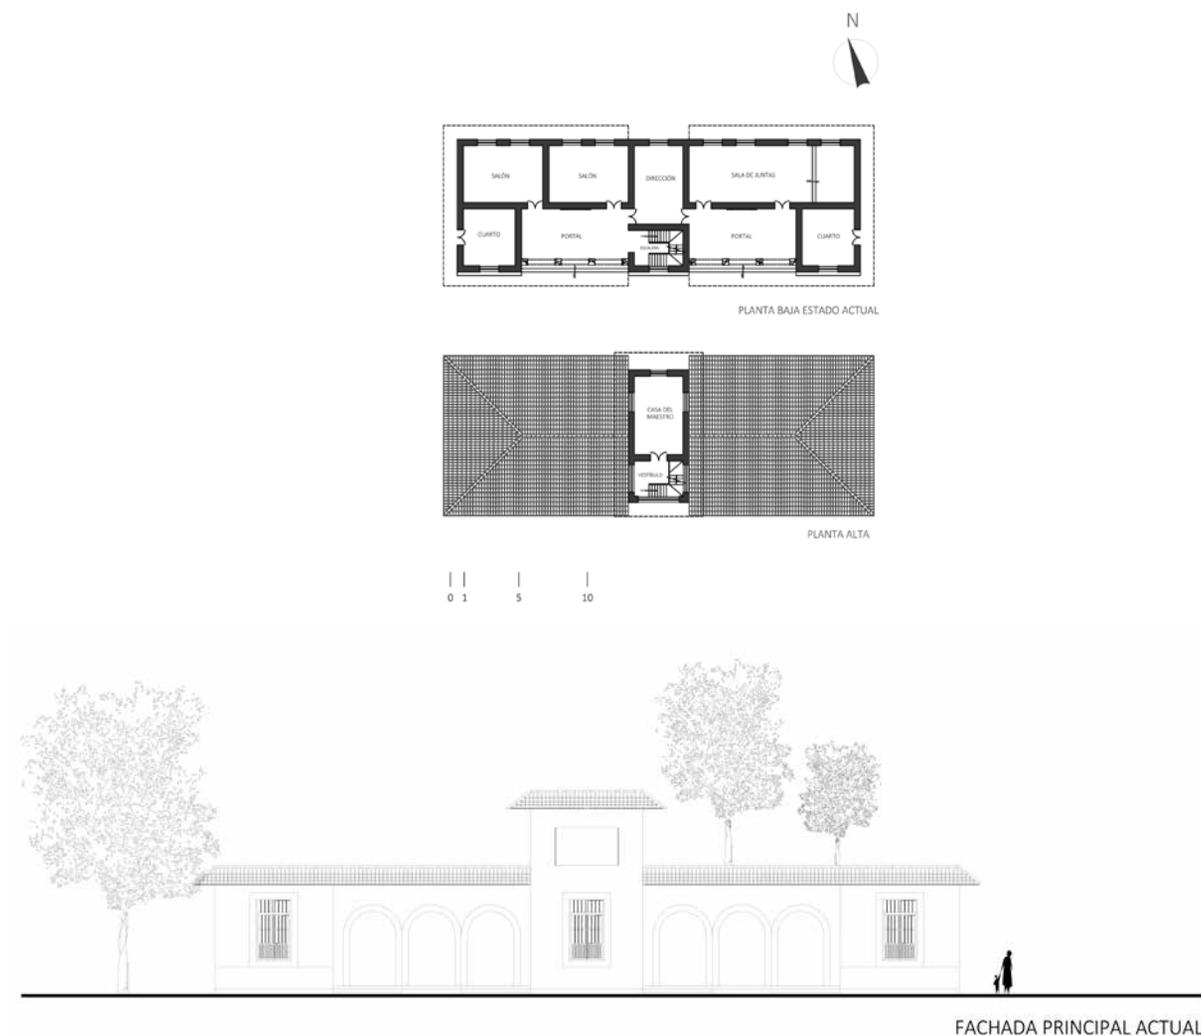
Planta arquitectónica y fachada de la escuela primaria Tzinzipandacuri construida en 1936.
